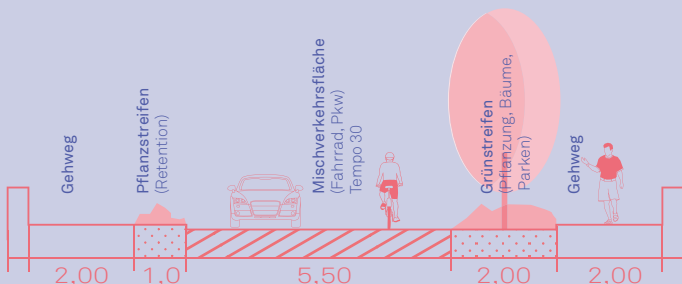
Schemaschnitt Hauptverkehrsstraße (z.B. Westerlandstraße)
